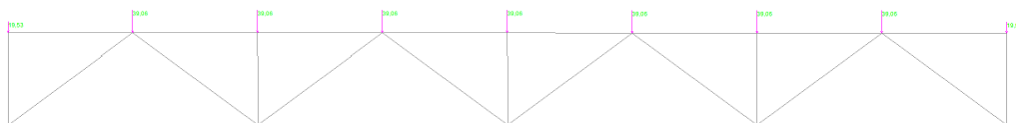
Схема навантаження у вузлах ферми прольотом 24 м
